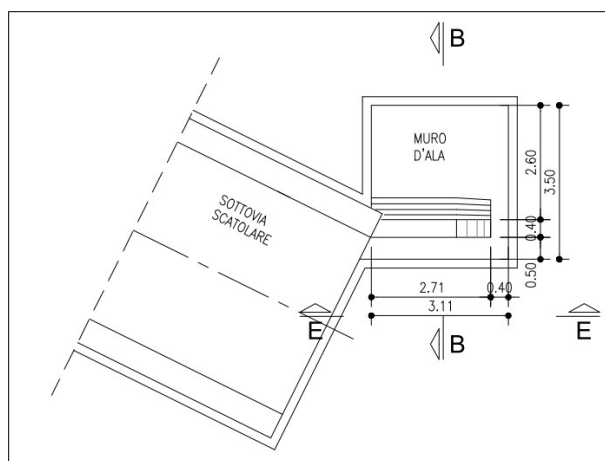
Planimetria del muro d'ala – Lato Nord
